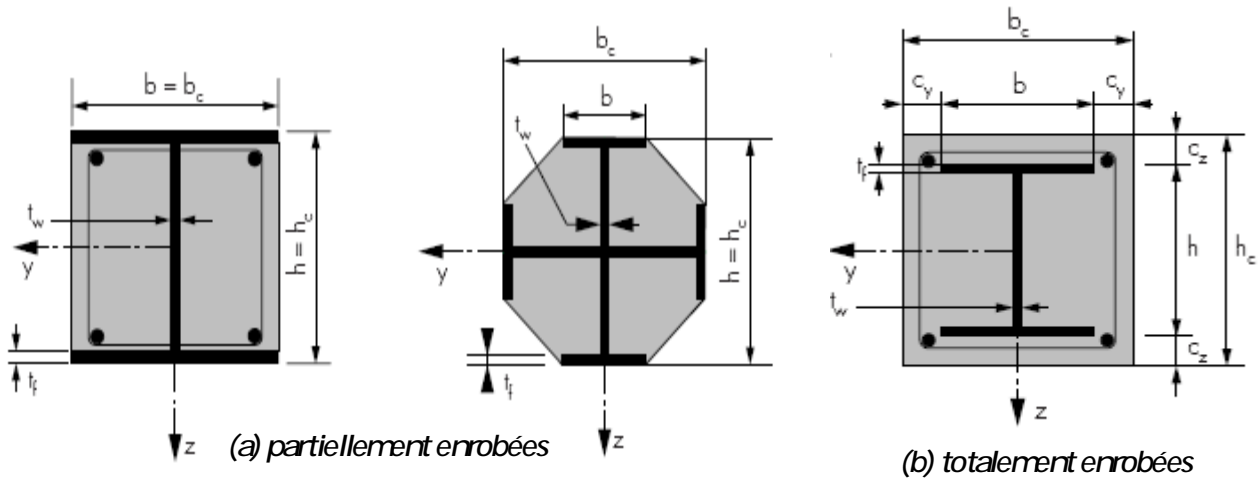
Exemples de colonnes mixtes partiellement ou totalement enrobées de béton
